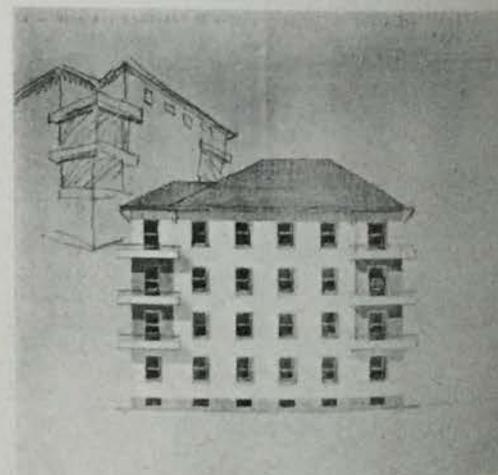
b - Casa Carpano: prospetto su via S. Eusebio con schizzo prospettico a matita.
